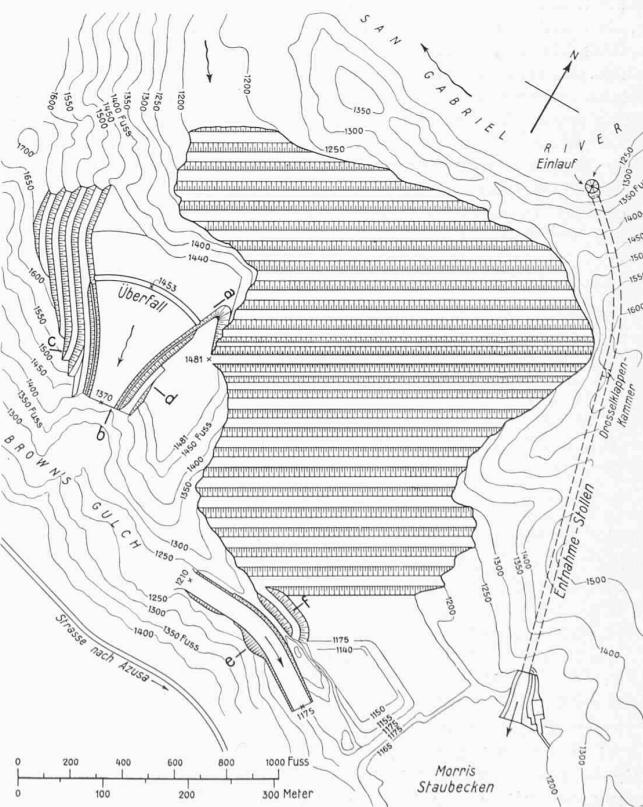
Lageplan 1:8000. Höhenkoten in Fuß ü. M.
